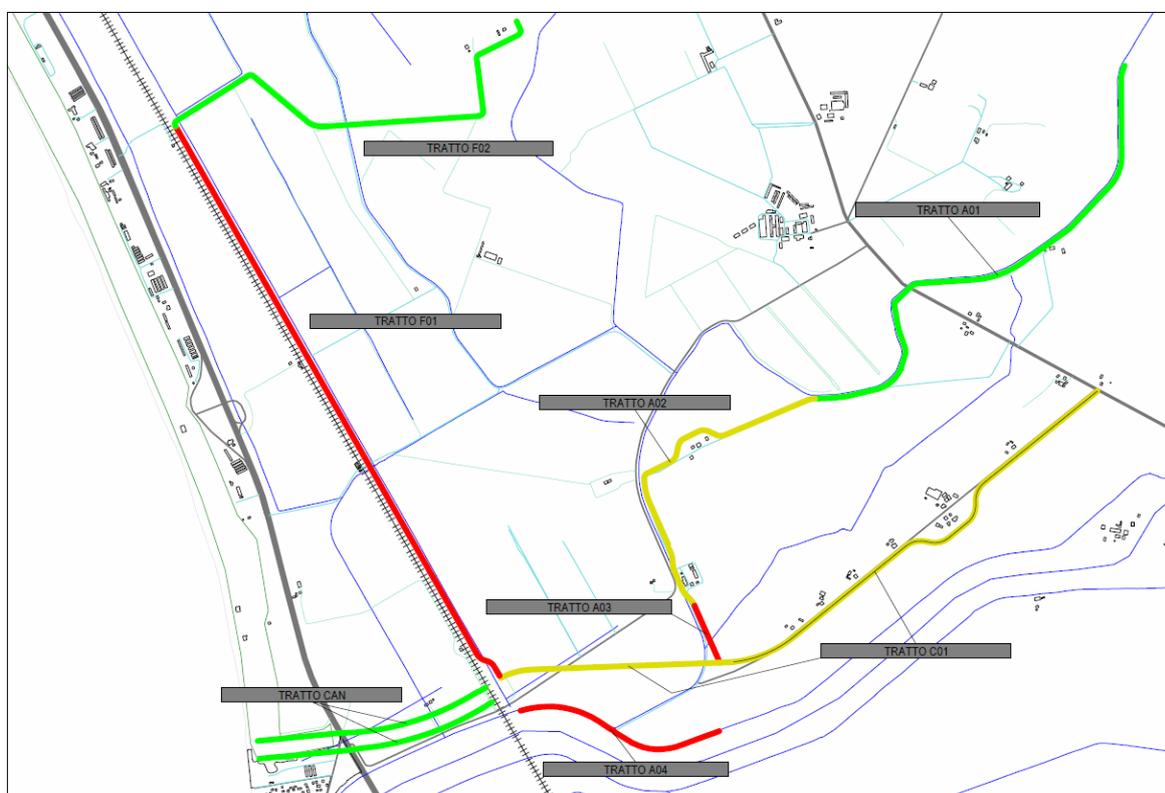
PLANIMETRIA DI PROGETTO DELLA CASSA D'ESPANSIONE E DEL CANALE SCOLMATORE – TRATTI ARGINALI.
